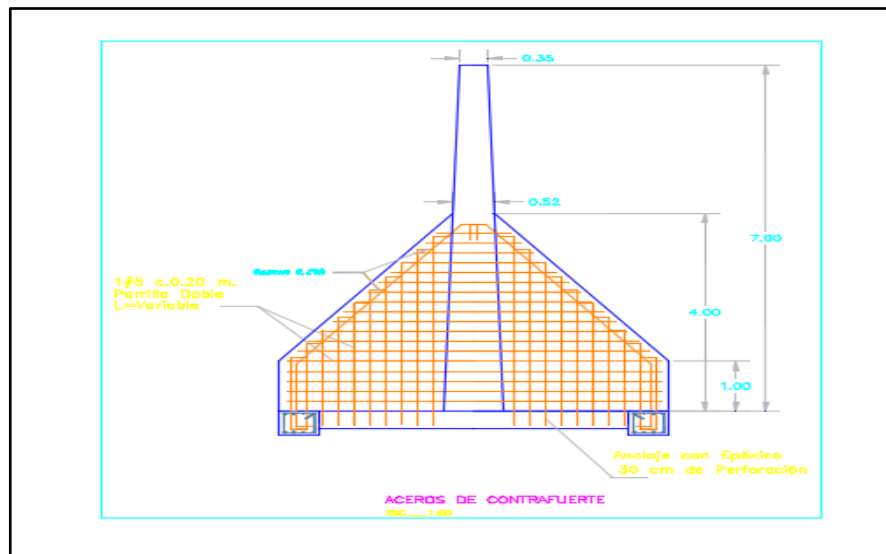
Vista en planta contrafuerte muros de contención del Box coulver k34+190
